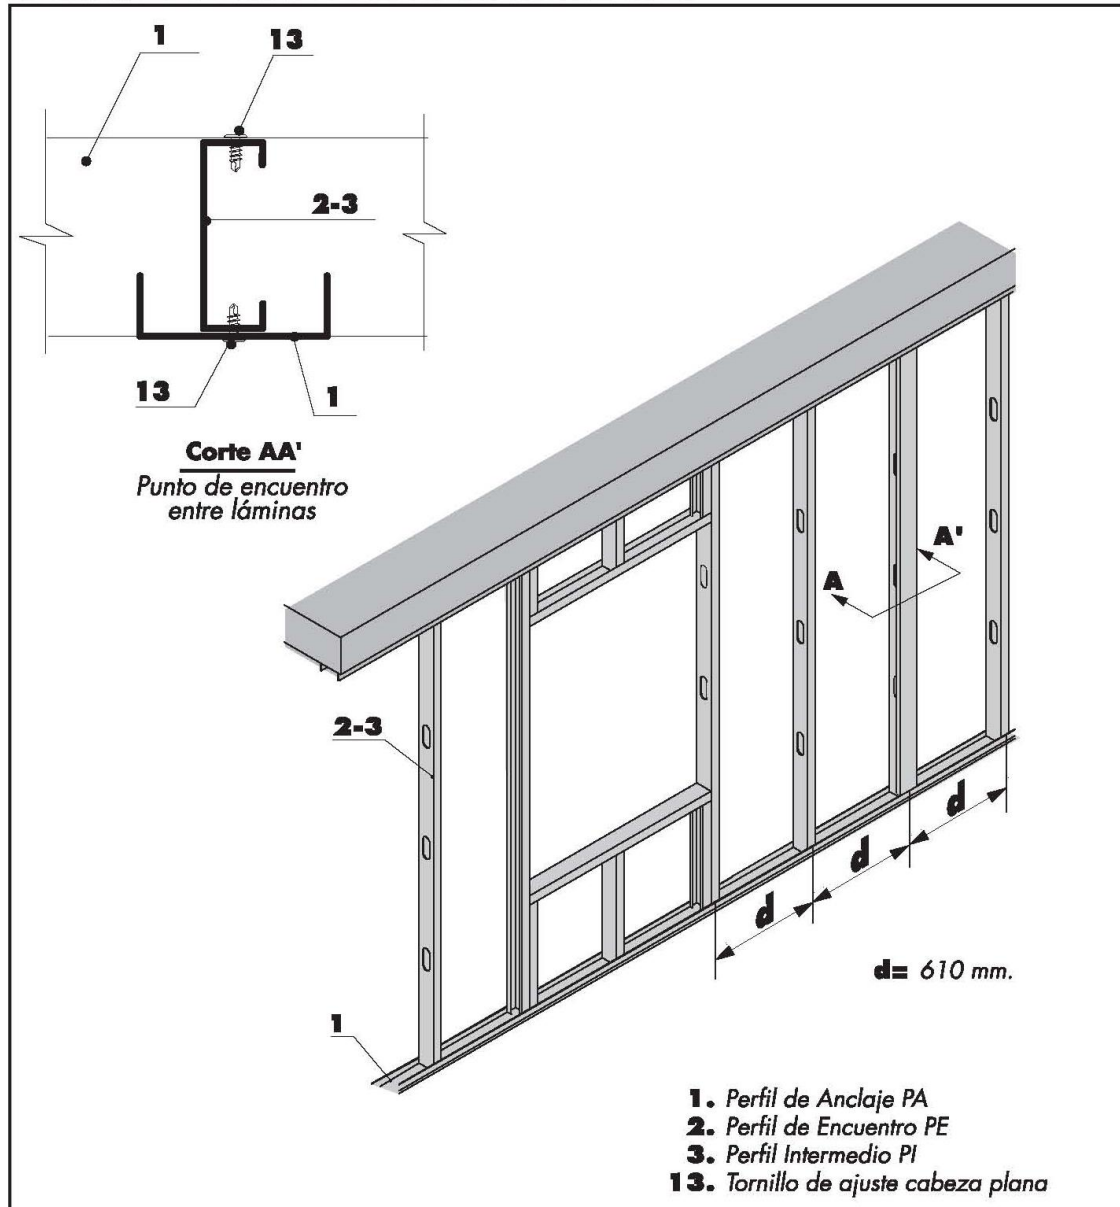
Detalle 7. Paredes exteriores. Ensamblaje de perfiles con separación de 610 mm [87].
